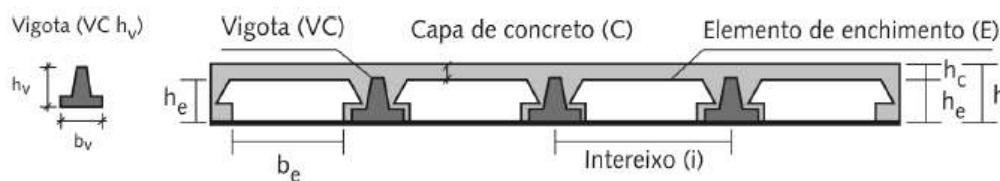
Laje com vigotas de concreto armado pré-fabricadas Fonte: NBR. 14859-1.
